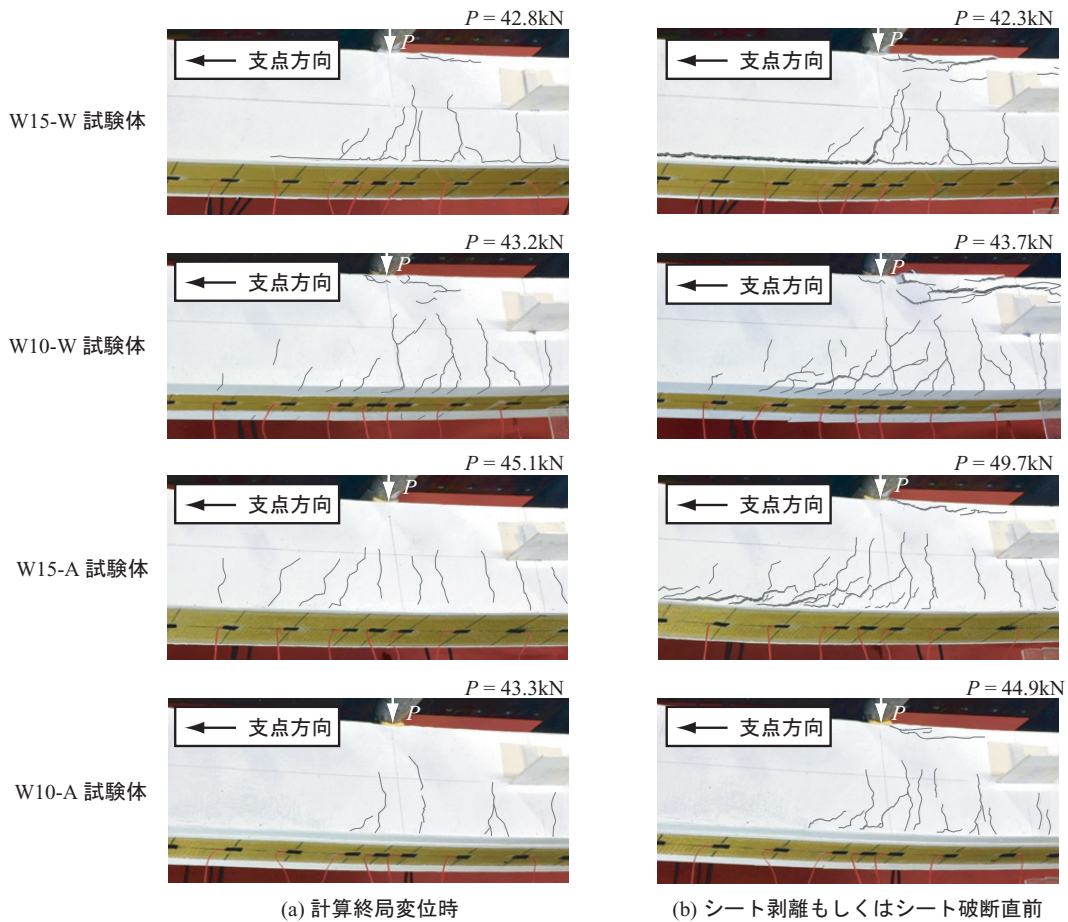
計算終局時および破壊直前におけるひび割れ性状
